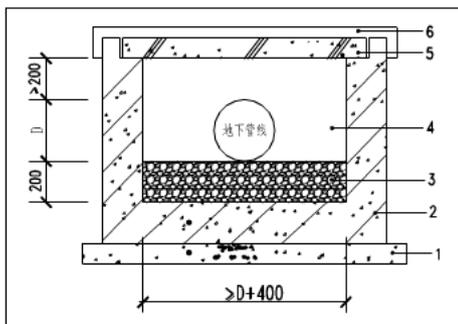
抗渗钢筋混凝土管沟防渗层示意图
